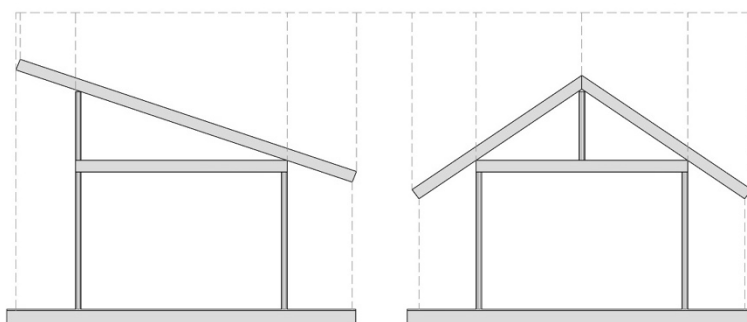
Ejemplos de cubierta de uno y dos planos.
